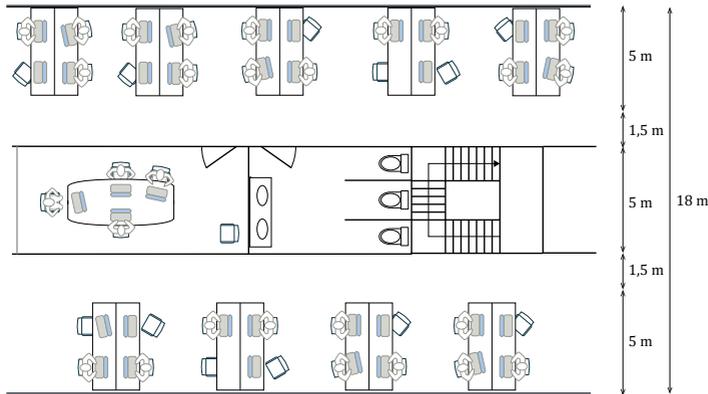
Organisation d'un plancher avec une profondeur de 18 m
